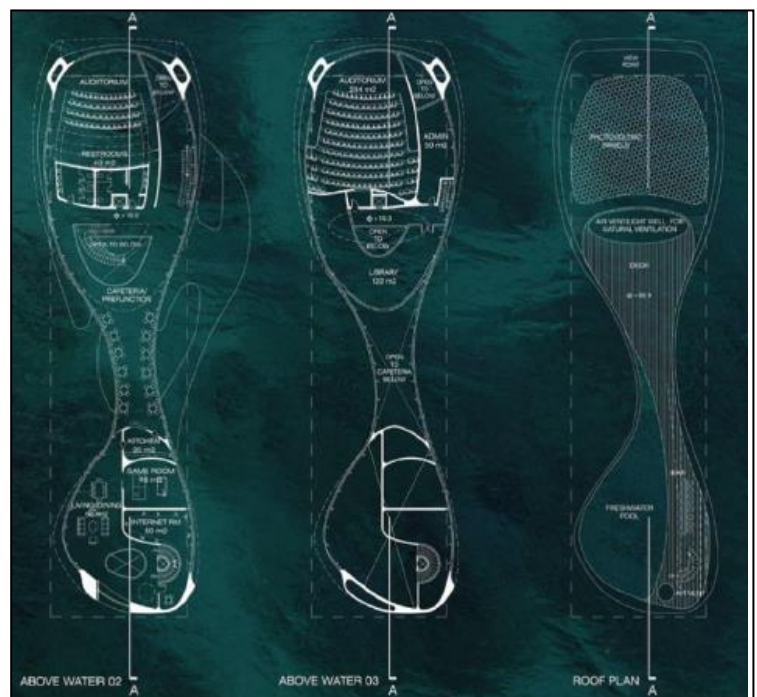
Plans du 2^{ème} et 3^{ème} niveau sur la mer et plan de terrasse⁴⁷
